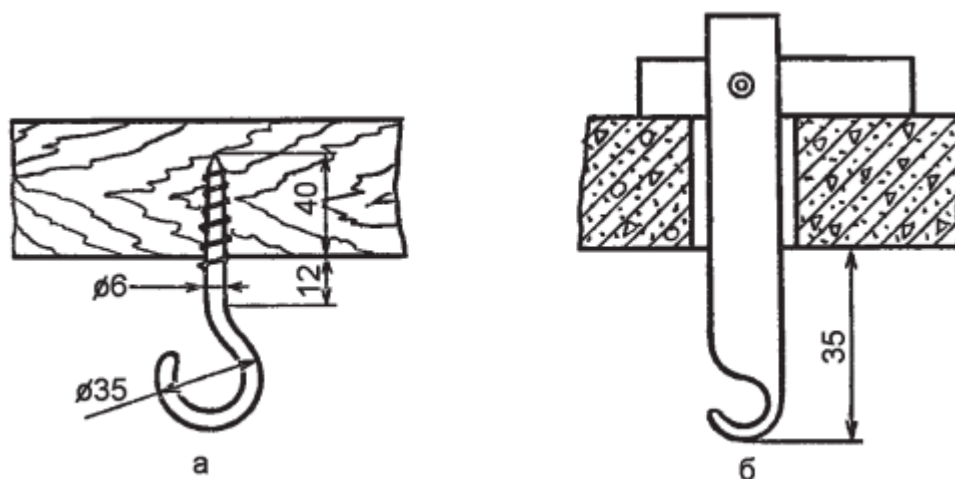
Крюки для подвески светильников: а – на деревянных потолках; б – на пустотелых железобетонных плитах
